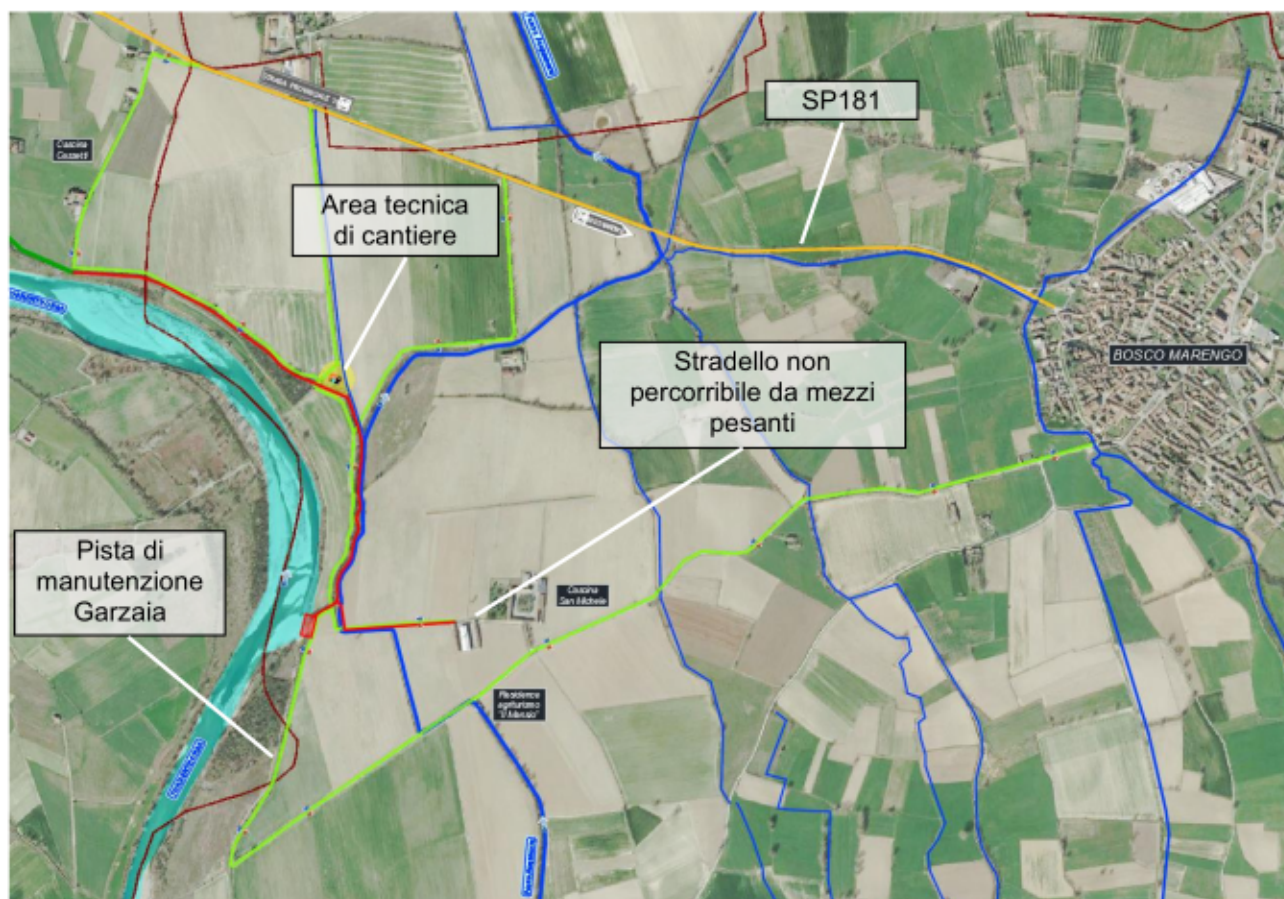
ESTRATTO DELLA PLANIMETRIA DEI PERCORSI DI CANTIERE - ELABORATO PD.14
